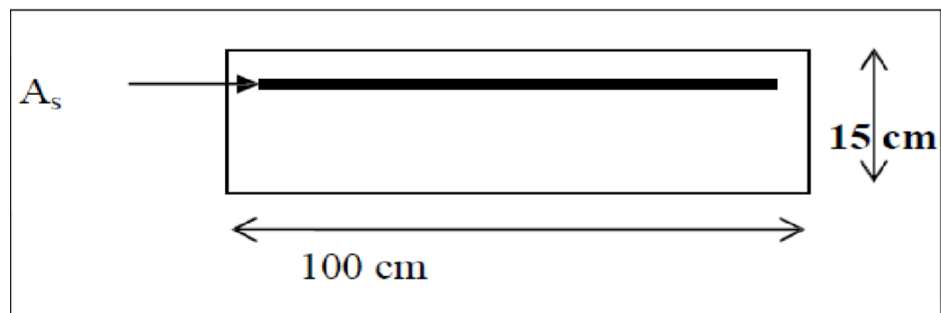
Coupe transversale d'un mètre linéaire du balcon.
